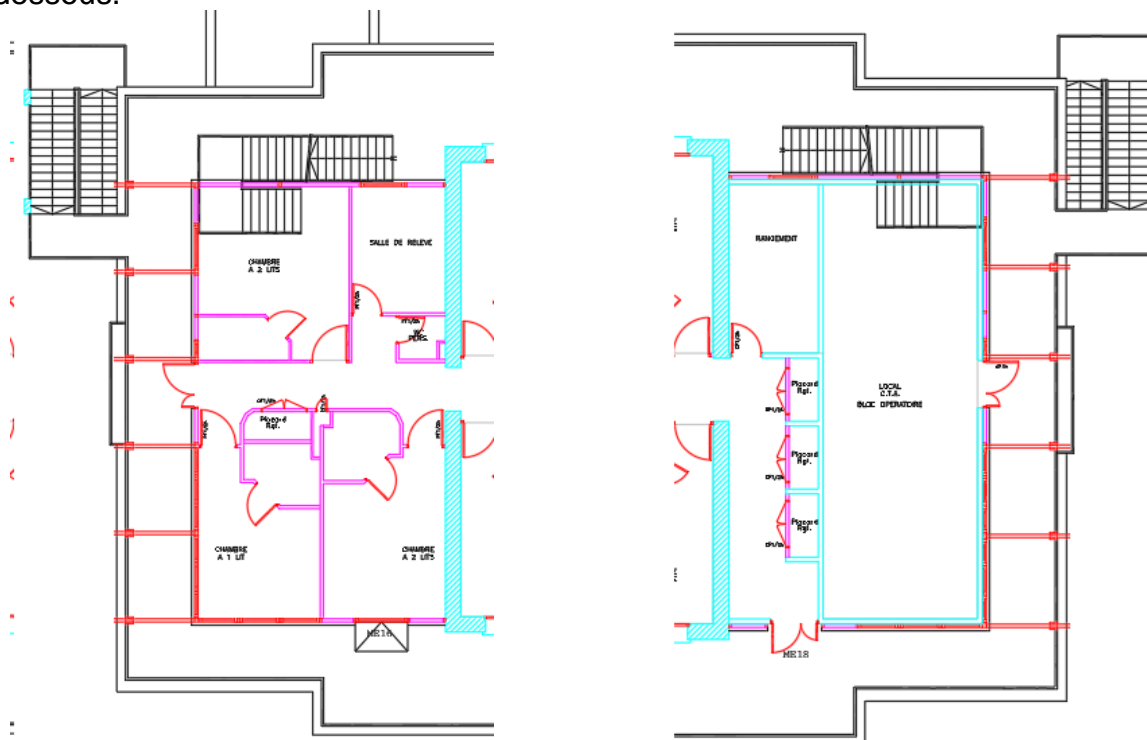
& 13 : Extrait plan archi R+2 aile Ouest & Est
